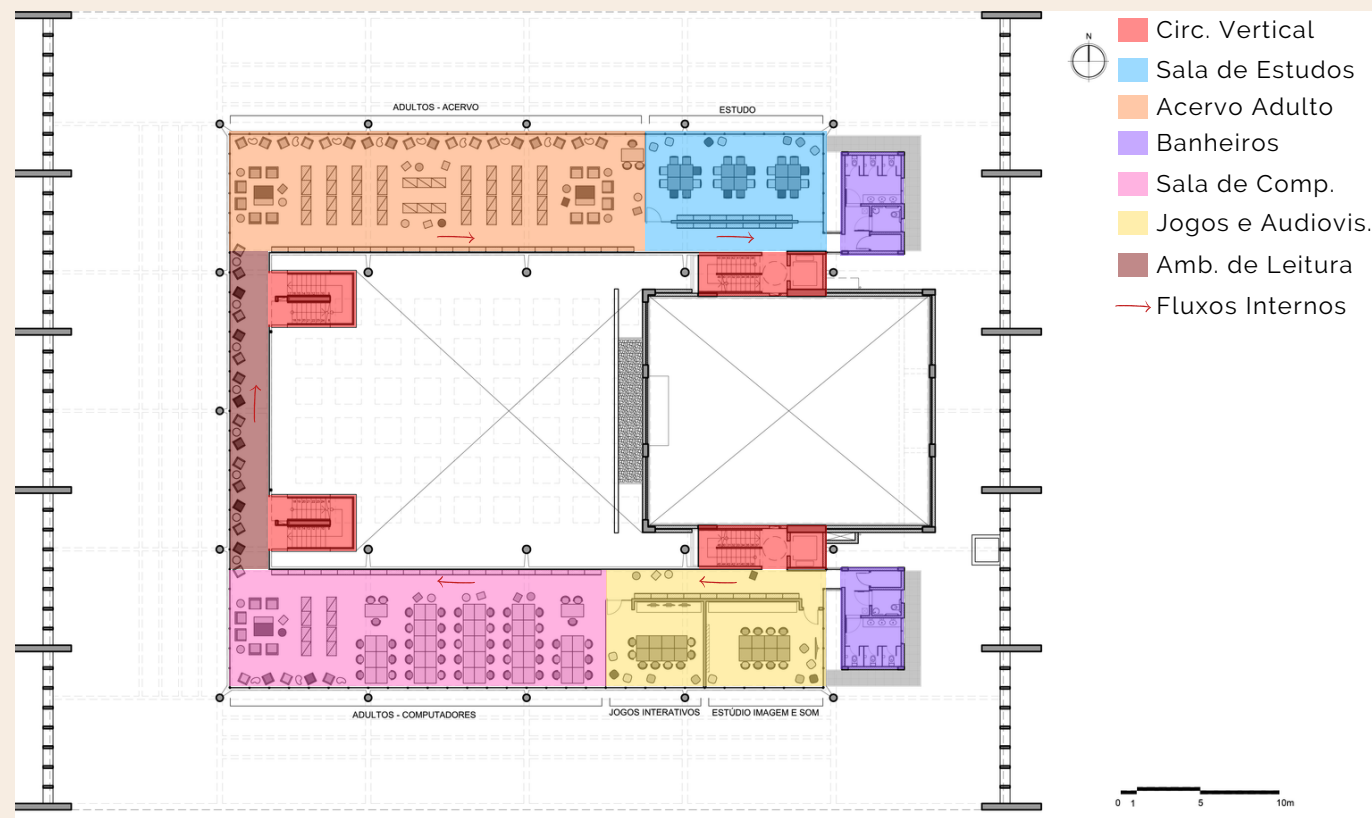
Fluxo e Setorização do Primeiro Pavimento BVL
